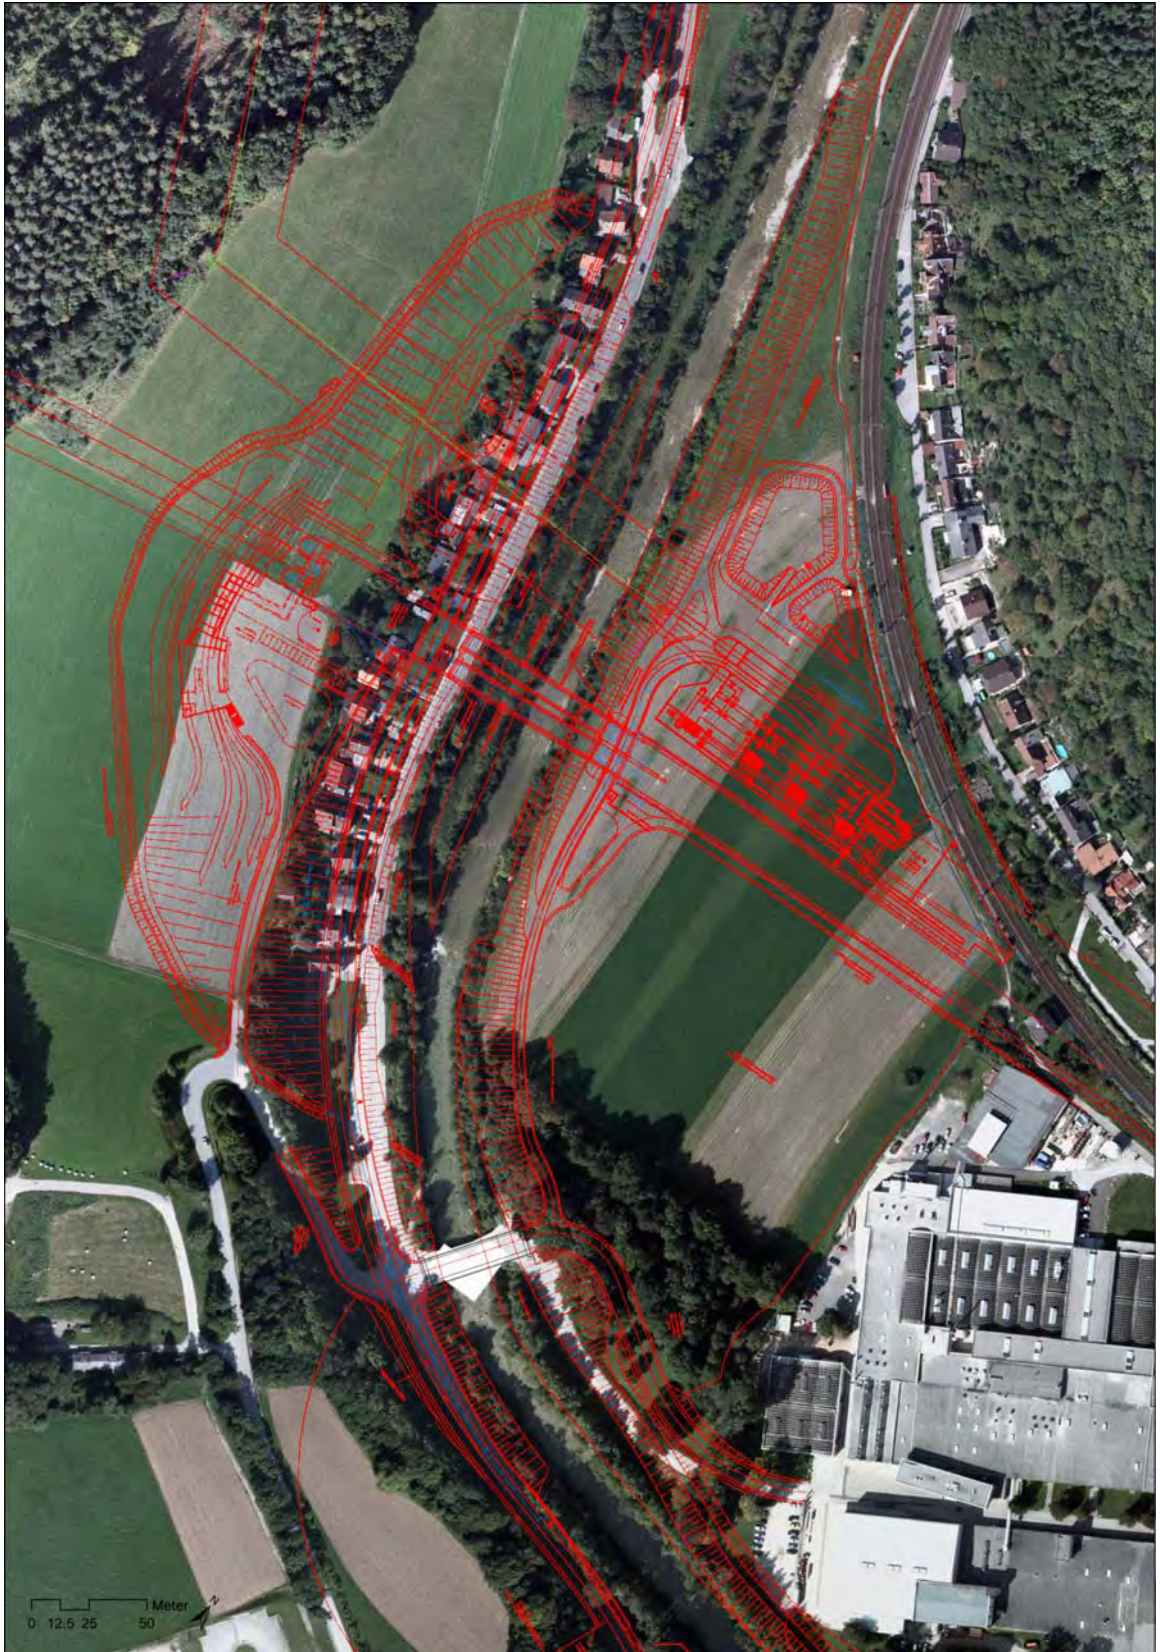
Ausschnitt Übersichtslageplan Portalbereich Gloggnitz
